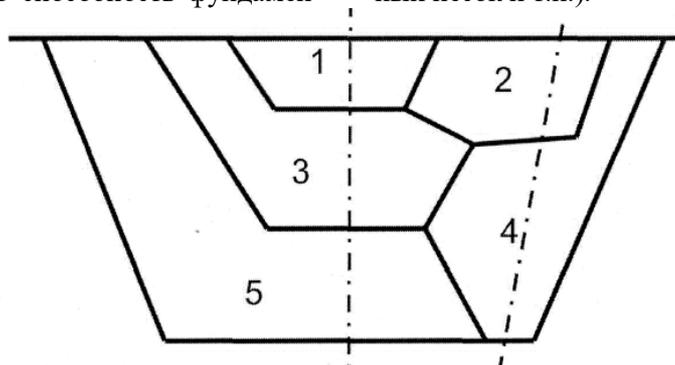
Последовательность вытрамбовывания котлована в два следа под спаренный фундамент у осадочного шва; 1...5 – этапы вытрамбовывания
